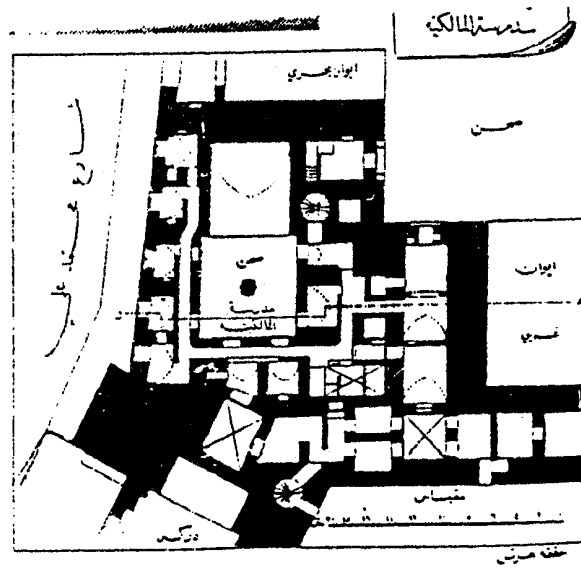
مسقط أفقي لمدرسة الناصر محمد بالقاهرة (عن Creswell)
